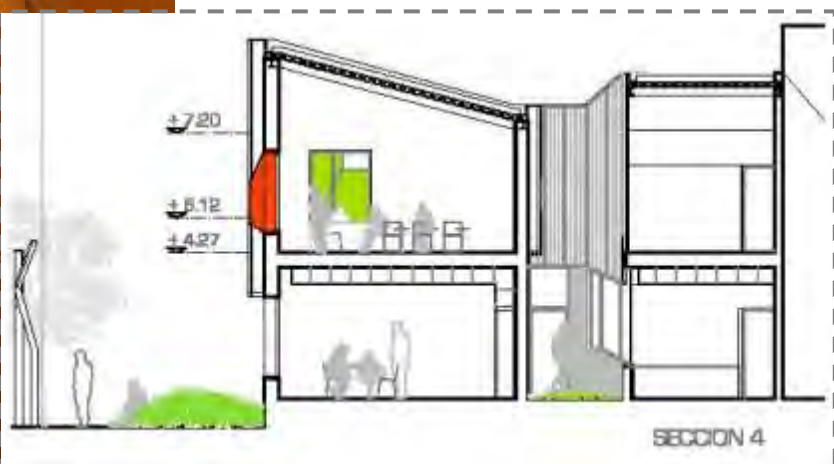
Se conjuga una losacero en la vieja estructura.
